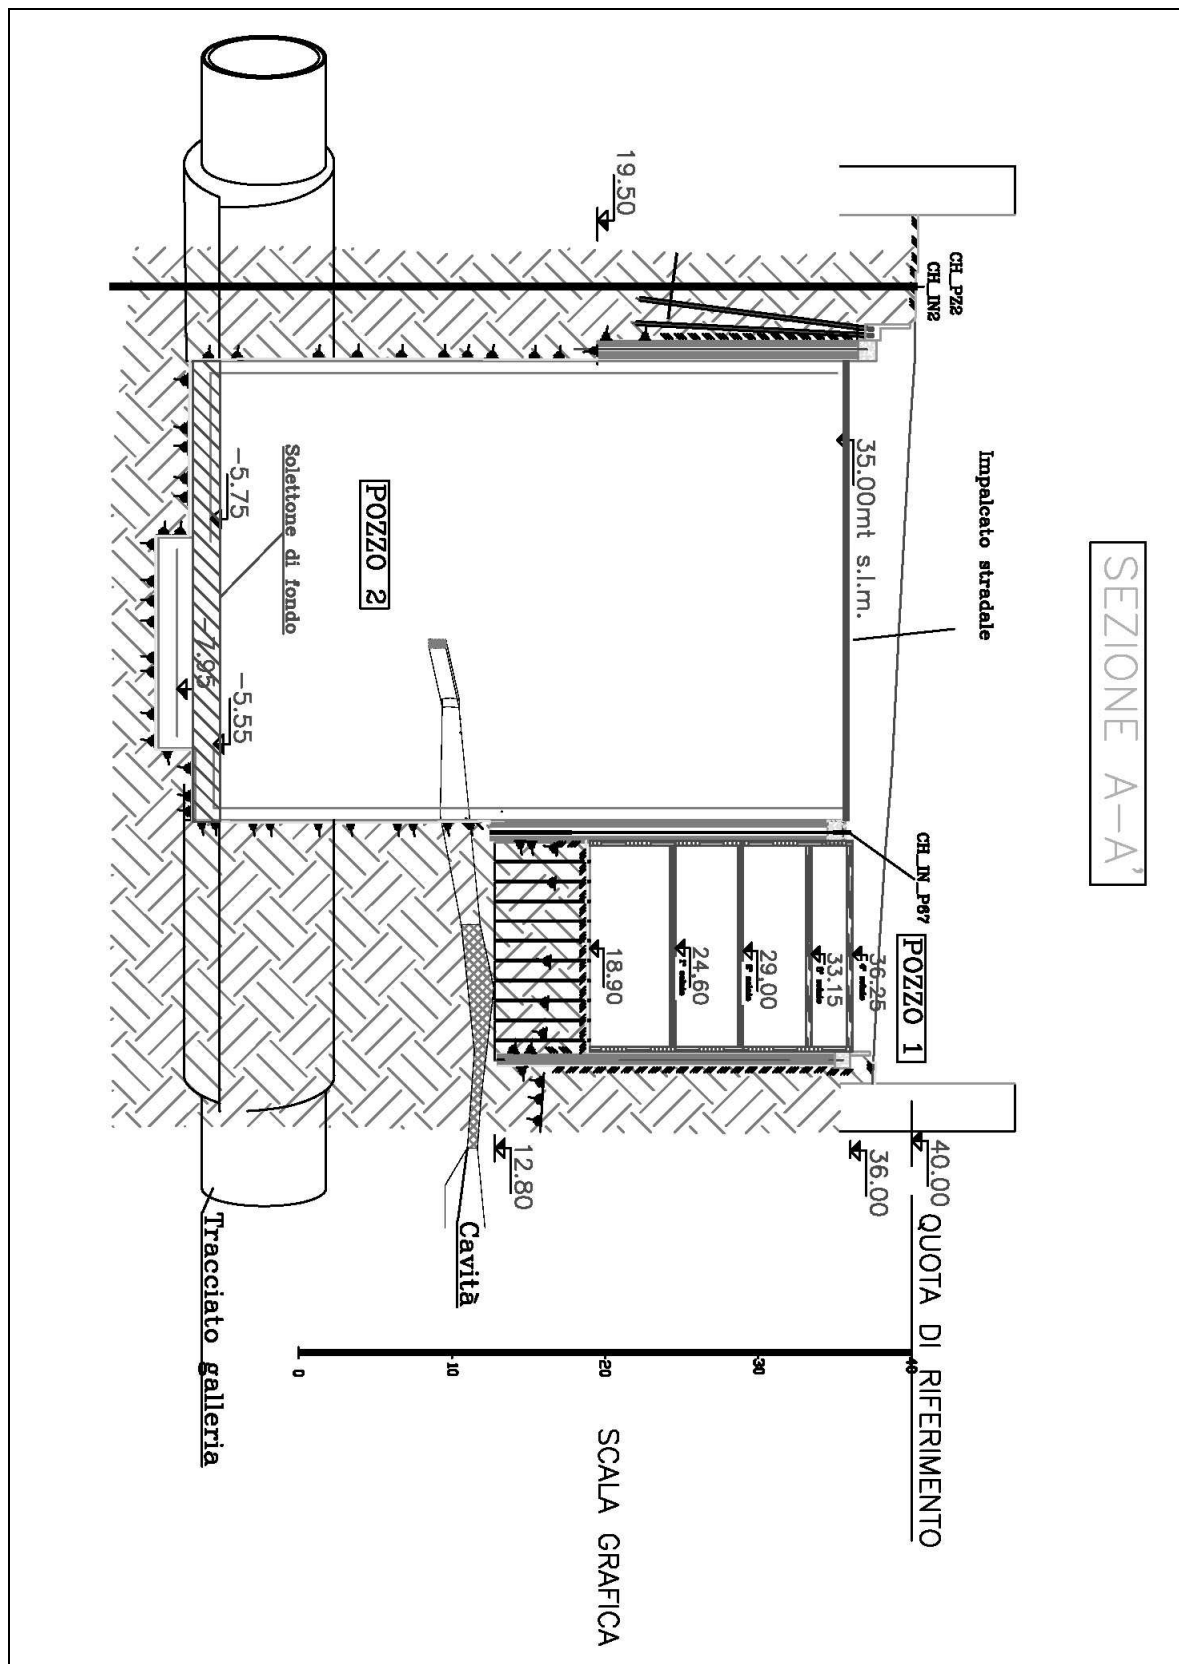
Sezione A-A' pozzo stazione, raffigurante la suddivisione in aree di lavoro.
